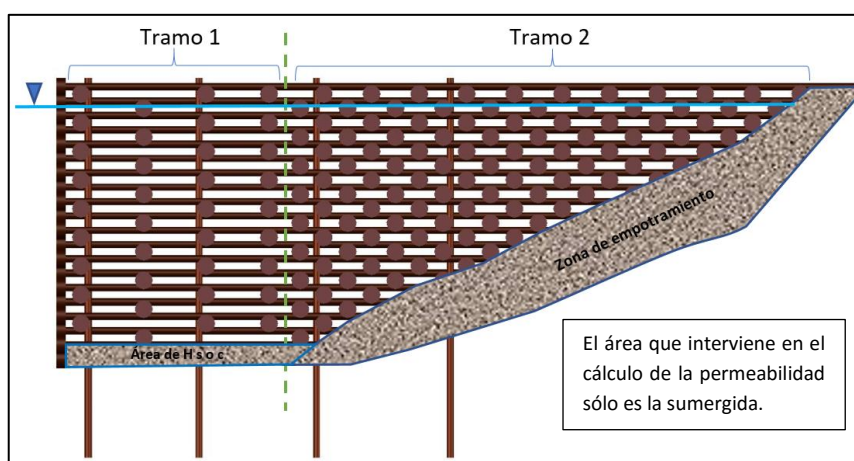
Vista en dirección del flujo, de un Espigón Fabricado con Troncos de Árboles.
